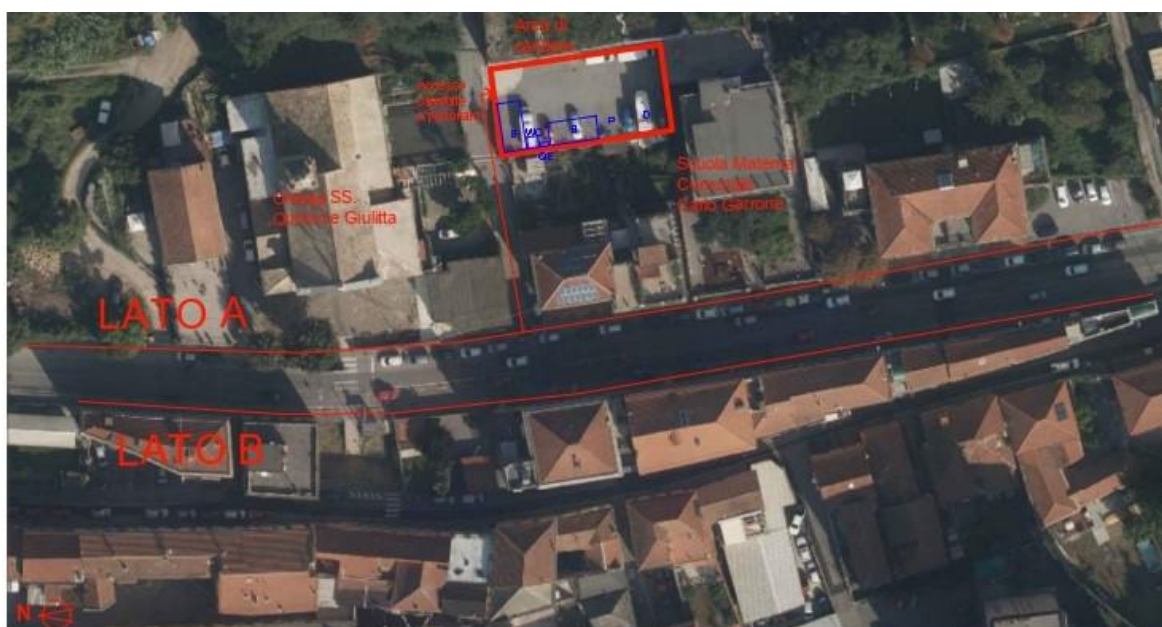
Possibile collocazione dell'Area di Cantiere
